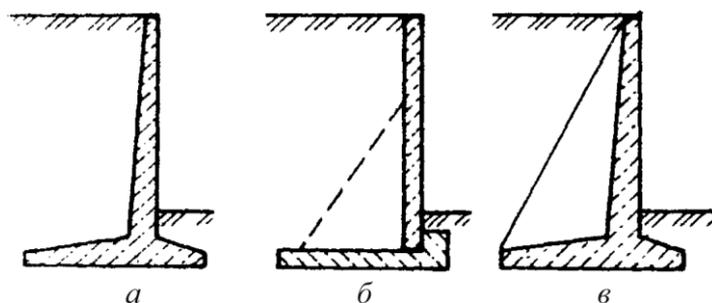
Тонкостенные подпорные стены: *а* – уголково консольные; *б* – уголково анкерные; *в* – контрфорсные
